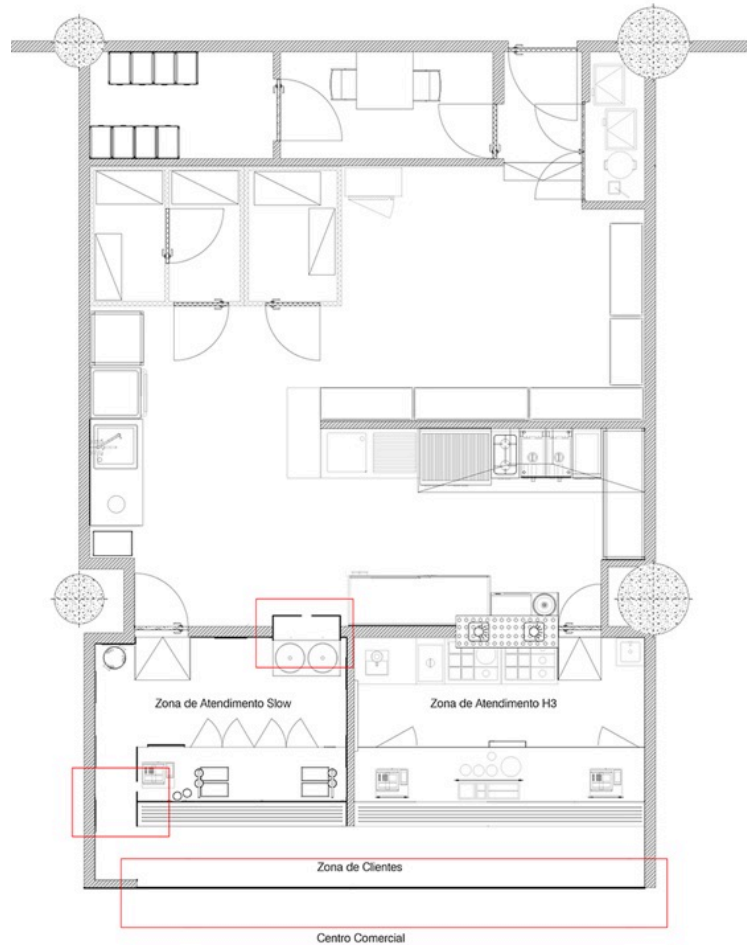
Planta da primeira proposta, com anotação das áreas a serem alteradas
